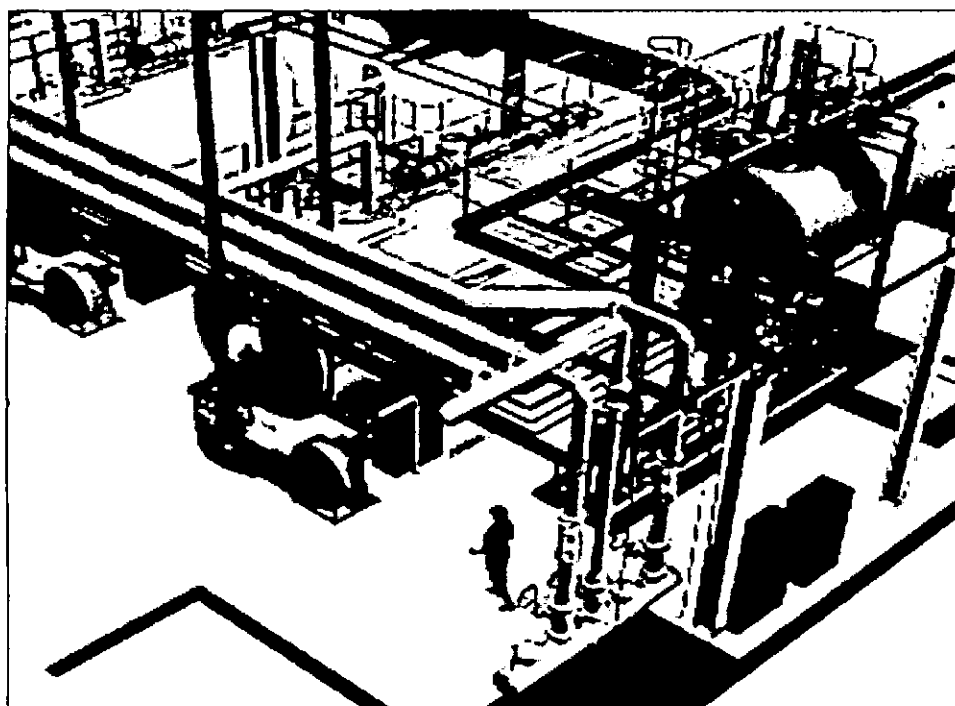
Arquitectura de la planta química PLA vista superior en 3D
